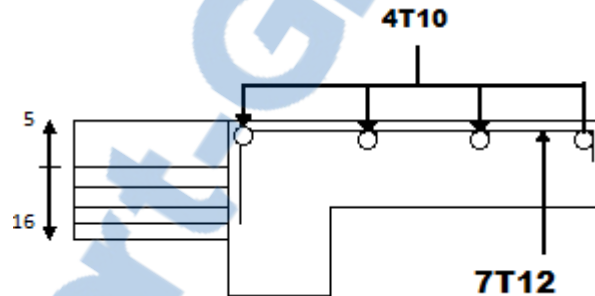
Ferrailage de la dalle pleine de type 1 étage courant
